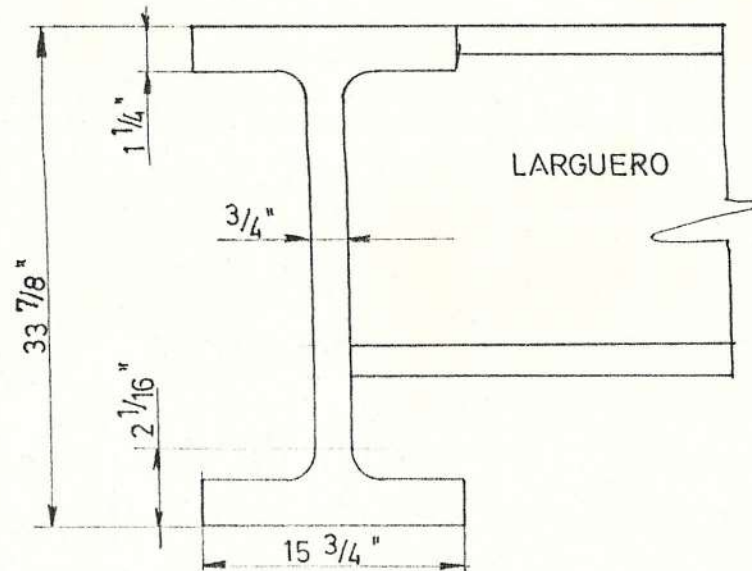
CONECCION VIGA DE PISO - LARGUERO.
